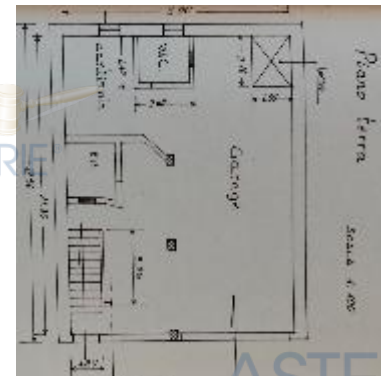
/2 - PLANIMETRIA STATO ATTUALE SUBALTERNO 2
